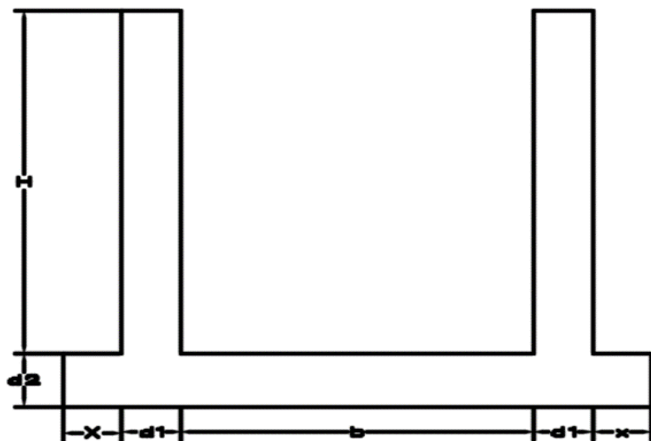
Sección típica de cuneta (Fuente: Walter Morales Uchofen)
